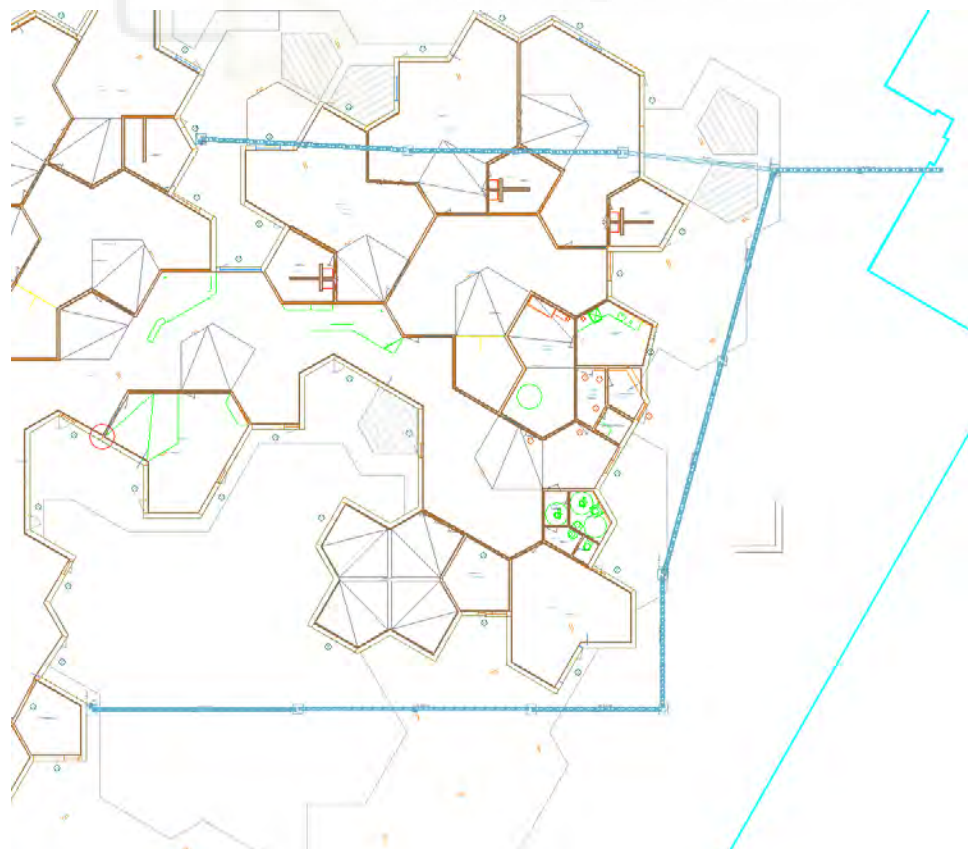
Vista planta - Saneamiento (Planta baja, pluviales)
